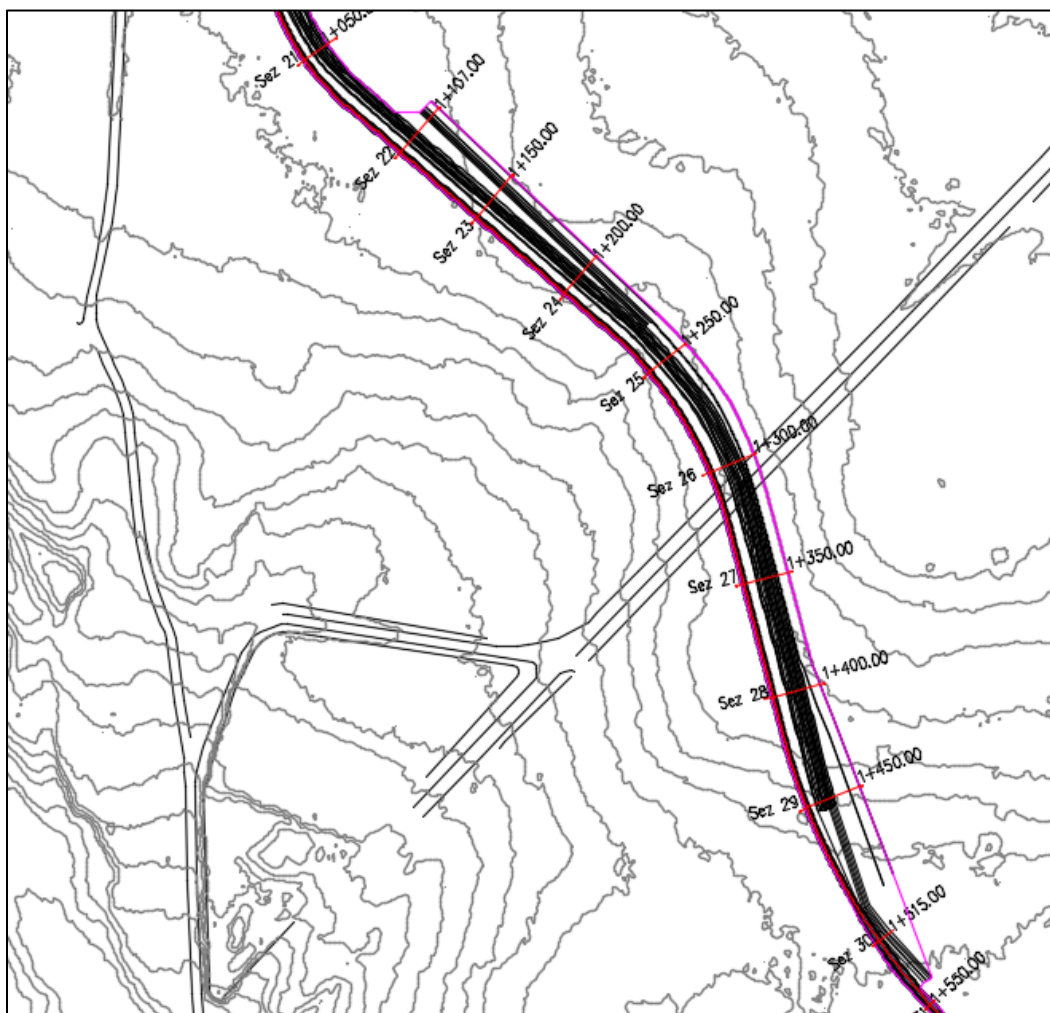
Stralcio planimetrico del canale con indicazione delle sezioni
